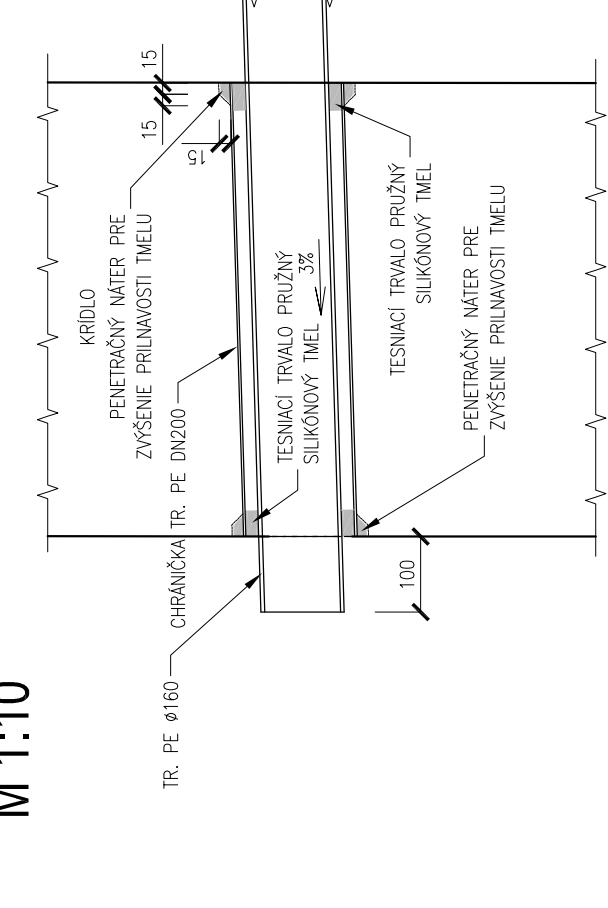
DETAIL - ÚPRAVA PRÍDILATÁCIÍ M 1:10
